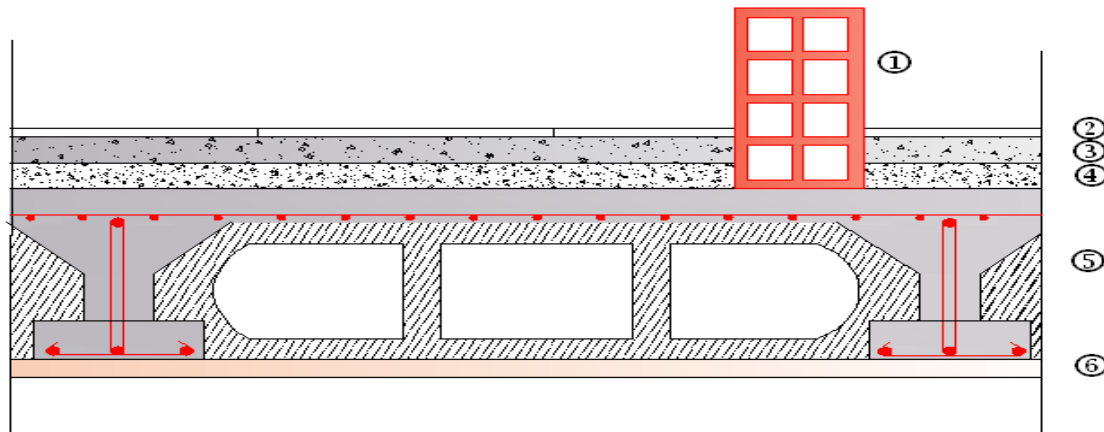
Coupe verticale d'un plancher étage courant (corps creux)
